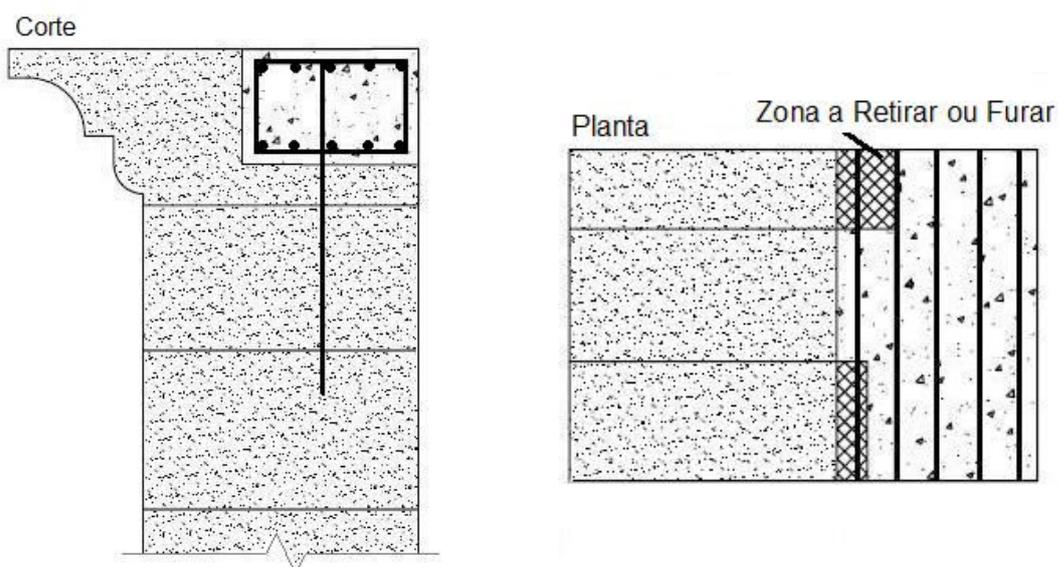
Cinta de coroamento e vista em corte e planta da parede na zona da cornija
